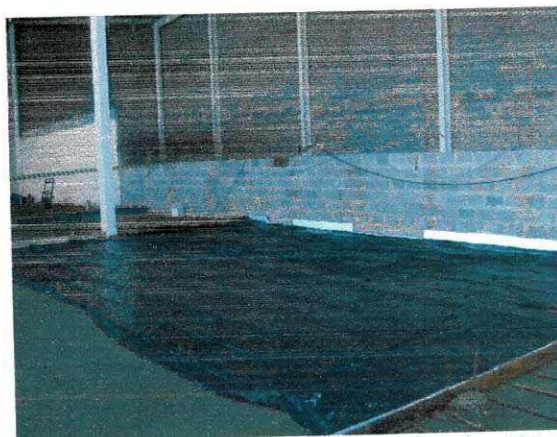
Aplicação de lonas para concretagem do piso (Fonte: Arquivo pessoal)
